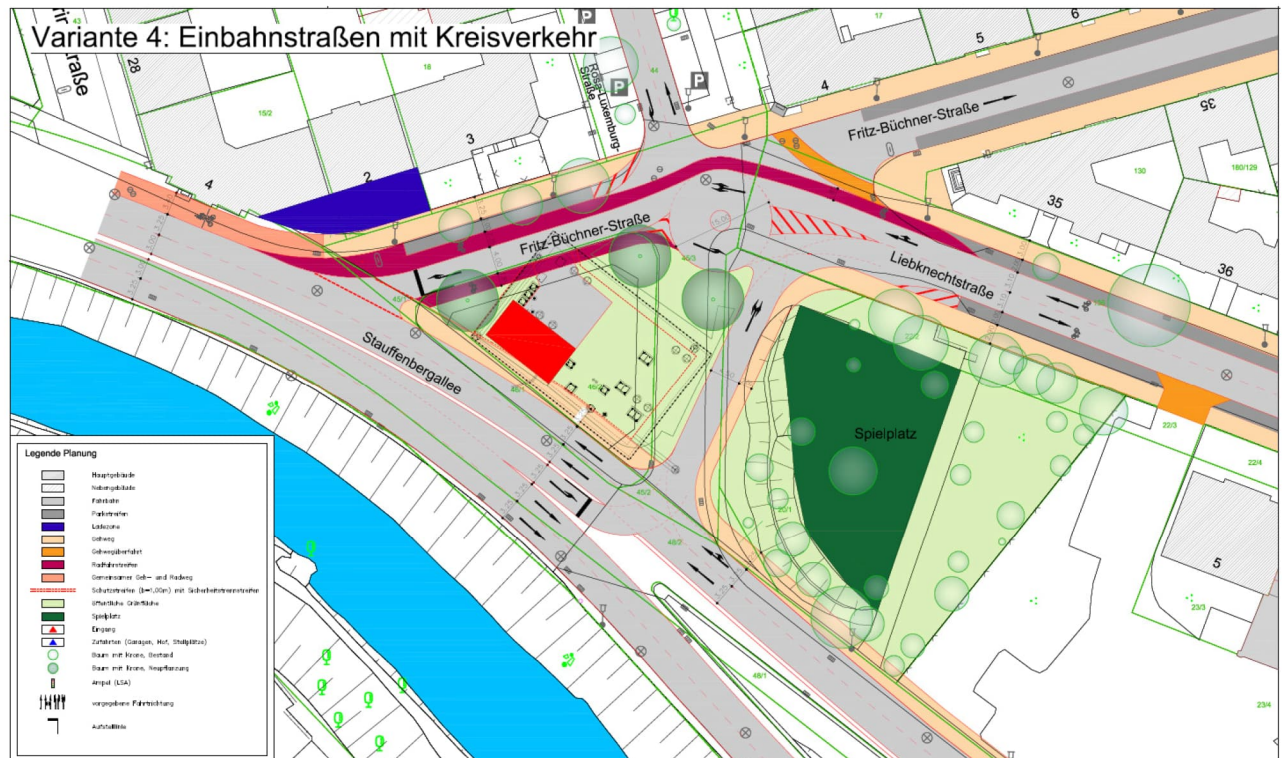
Variante 4 – Einbahnstraßen mit Kreisverkehr
